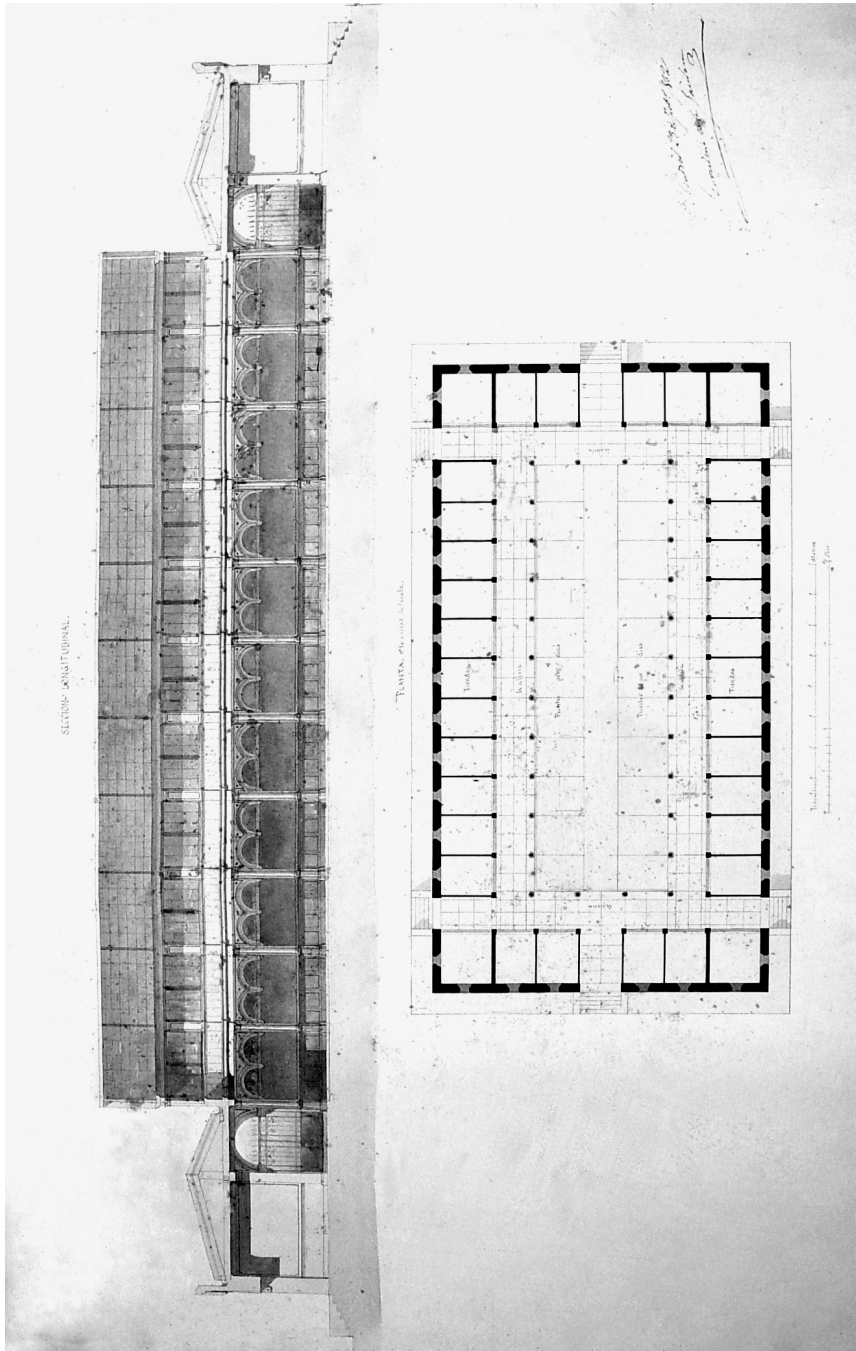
Proyecto de mercado para la plaza de Portugalete (sección longitudinal y planta). Jerónimo de la Gándara. 1862.
